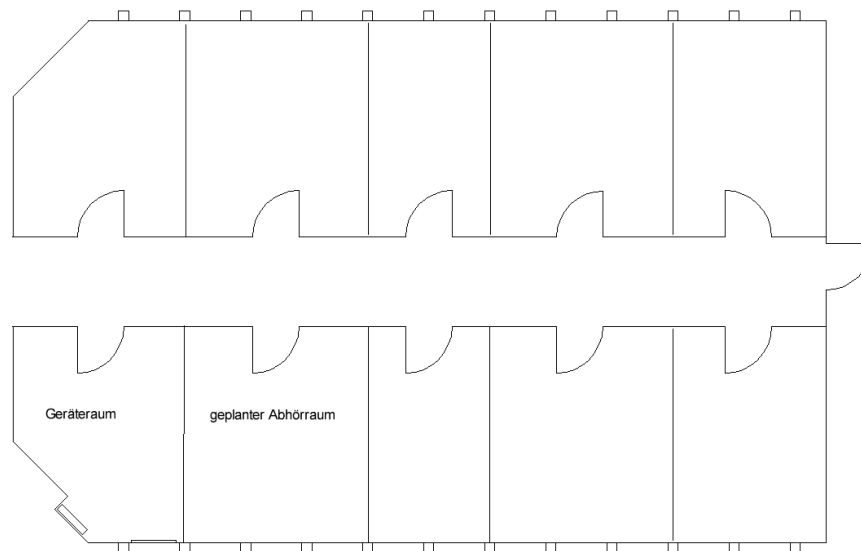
Gebäudeetage mit Büroräumen und geplantem Mehrkanal-Abhörraum
